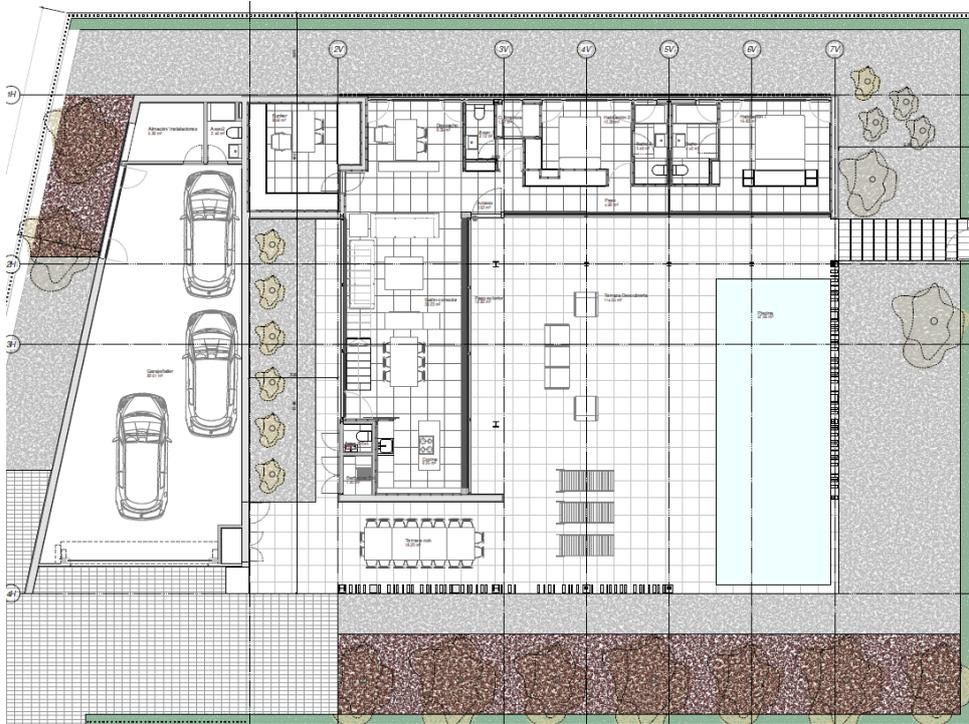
Plano de planta baja. 2019. Planos del Proyecto
